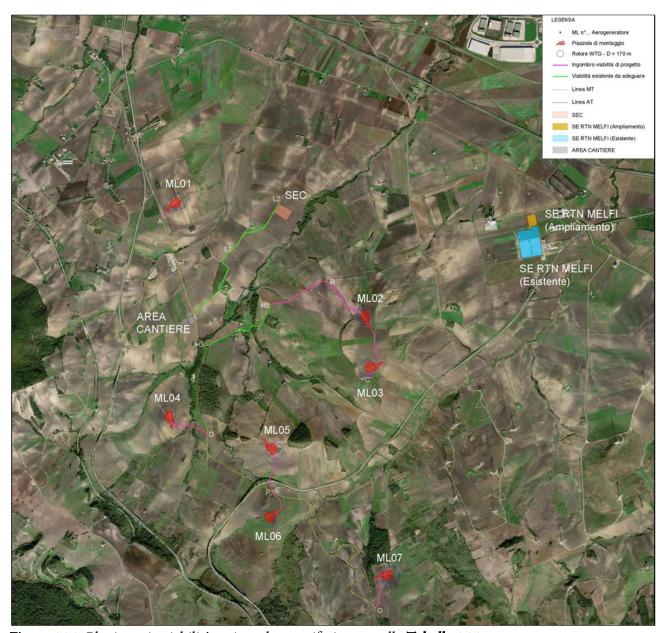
Planimetria viabilità e piazzole con riferimento alla Tabella 16.1
